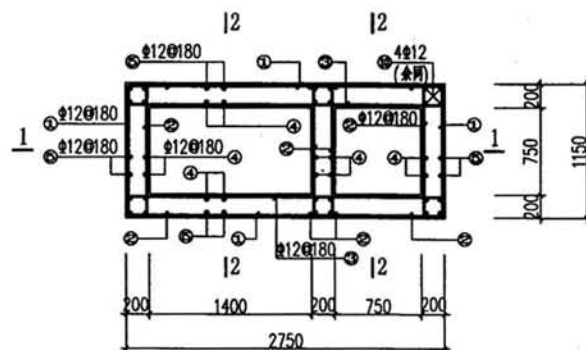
号钢筋混凝土化粪池配筋图(无覆土)		图号	08J09
